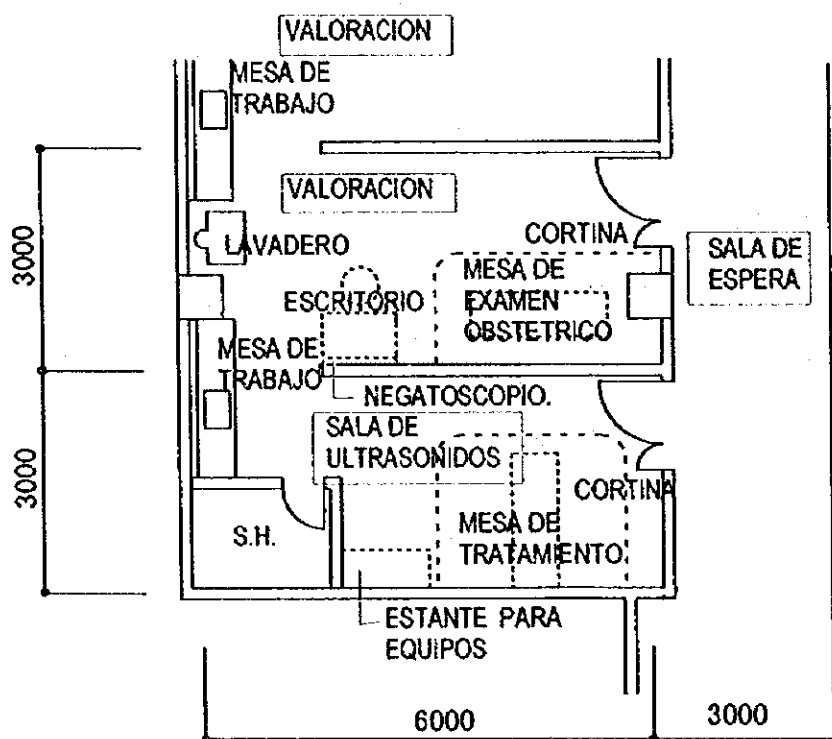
Plano de planta de las salas de examen y tratamiento de Emergencia
